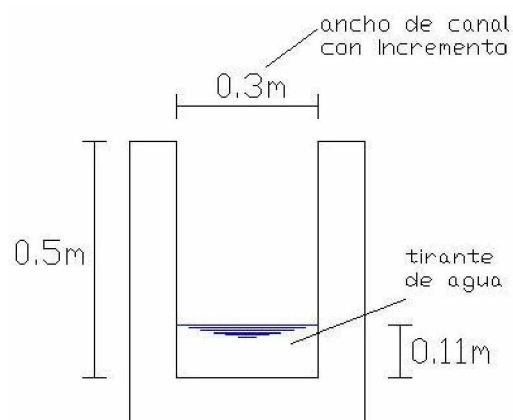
Sección del canal de las rejillas para la Planta N°1
